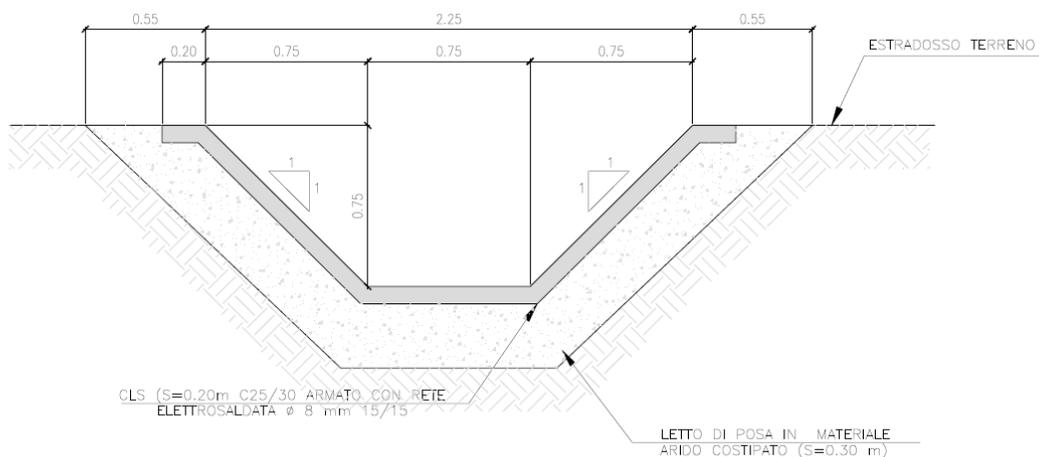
Sezione tipologica fosso di guardia trapezio.
